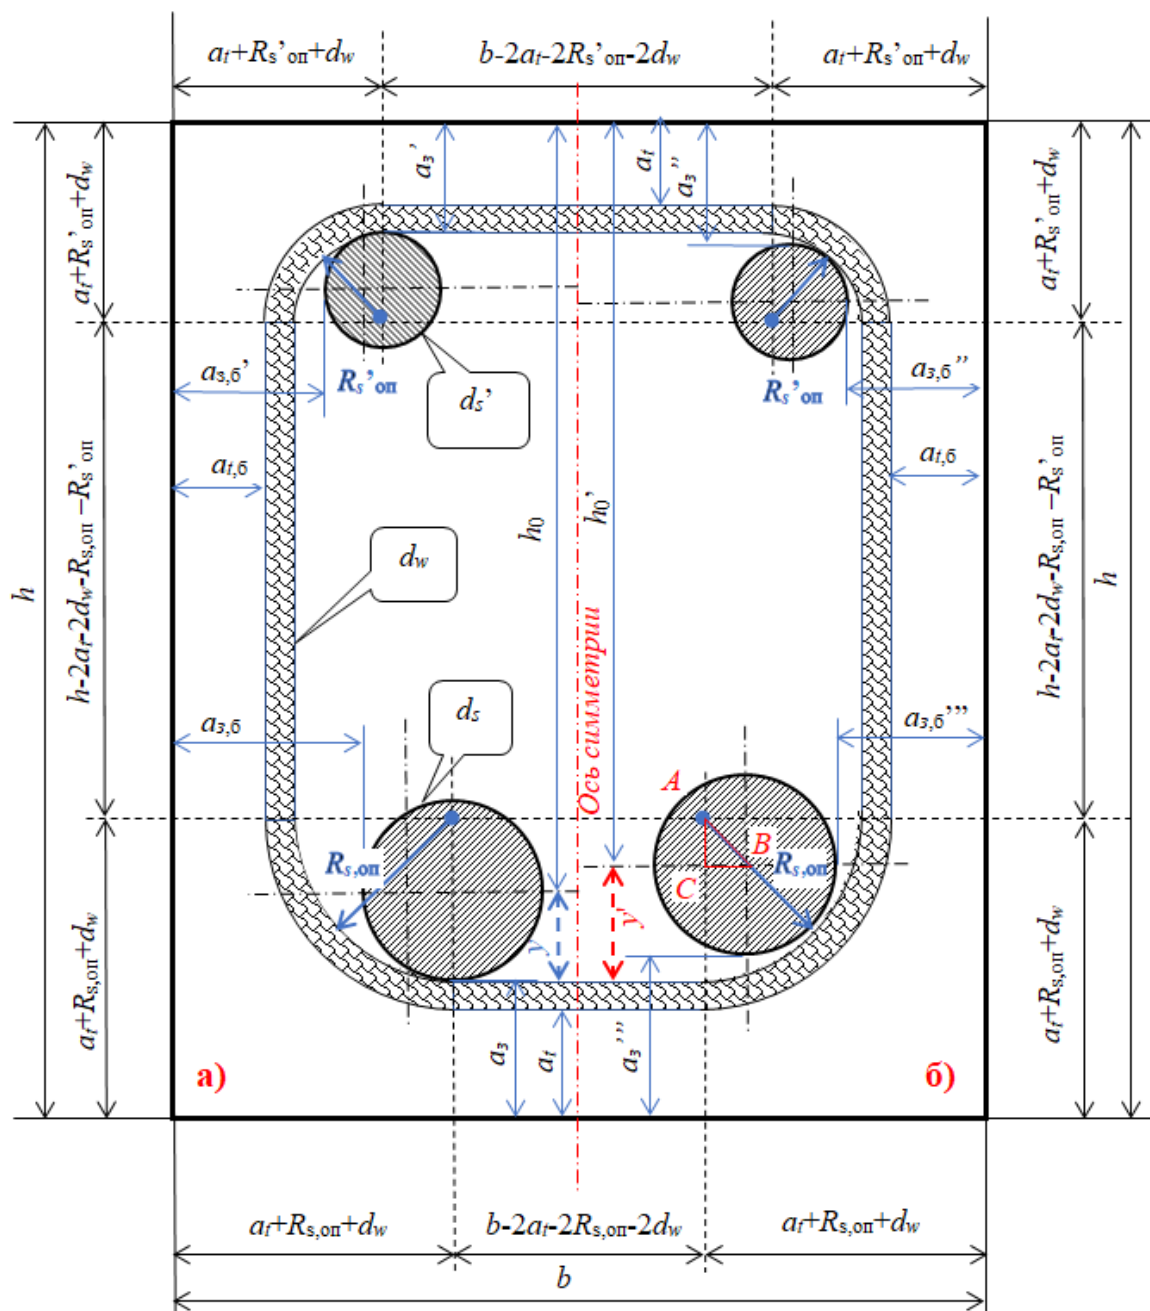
Поперечное сечение балки с армированием с учетом загиба вокруг оправок:
